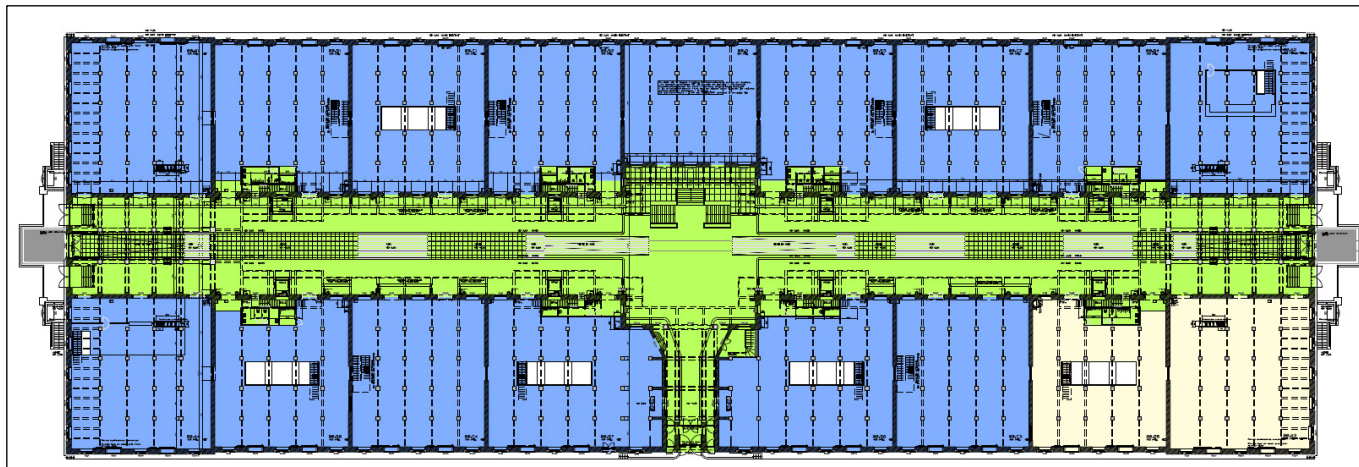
, Bâtiment B, situation existante de droit – 1<sup>er</sup> étage
